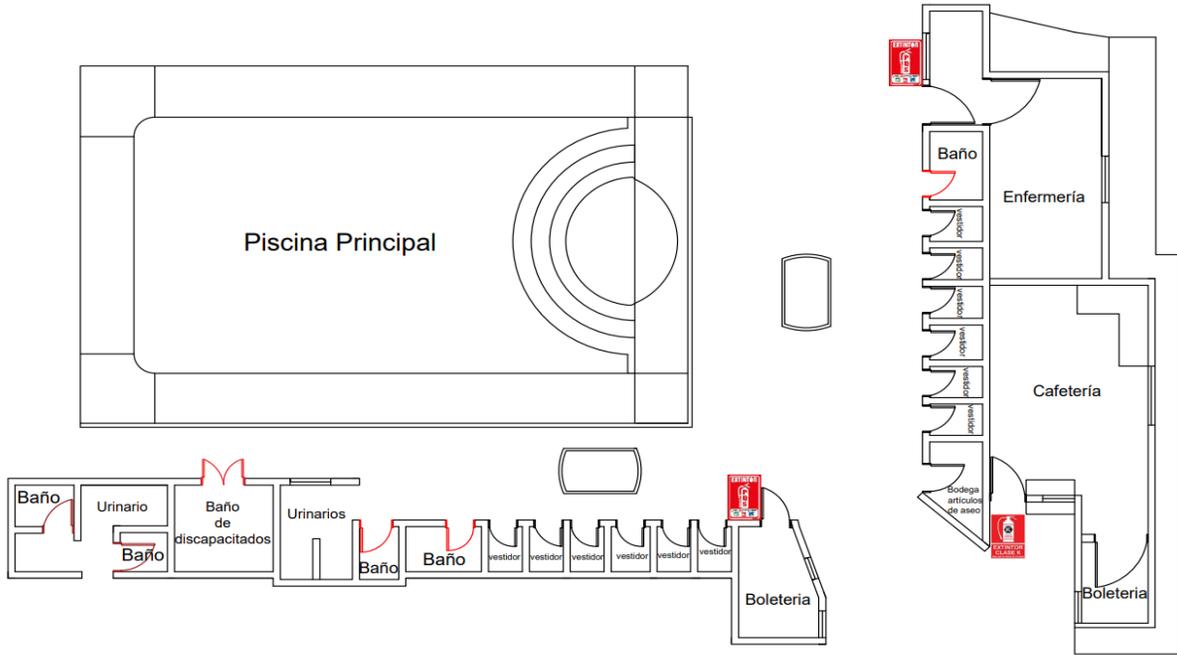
Ubicación de extintores boletería, cafetería y enfermería
